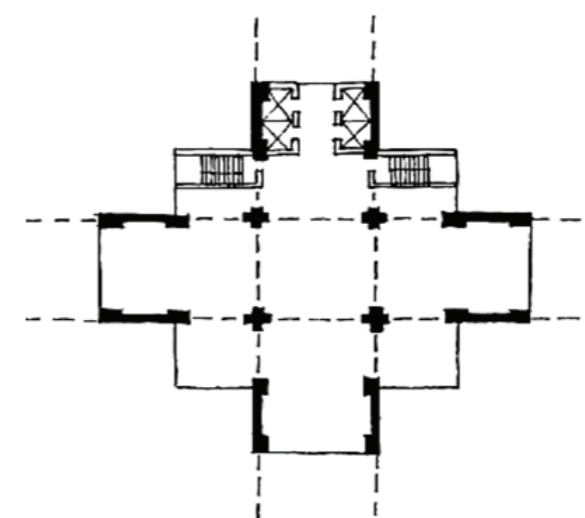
Wappenstein, Ovidio. Planta Tipo Edificio COFIEC (1974).
